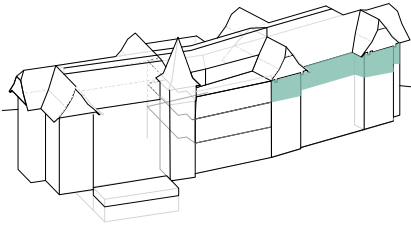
| Grundriss Abbruch/Neubau O0
